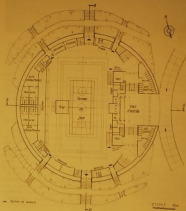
Plan de la salle au niveau du soubassement, et indiquant les fondations, et les plans de construction qu'il y a.
